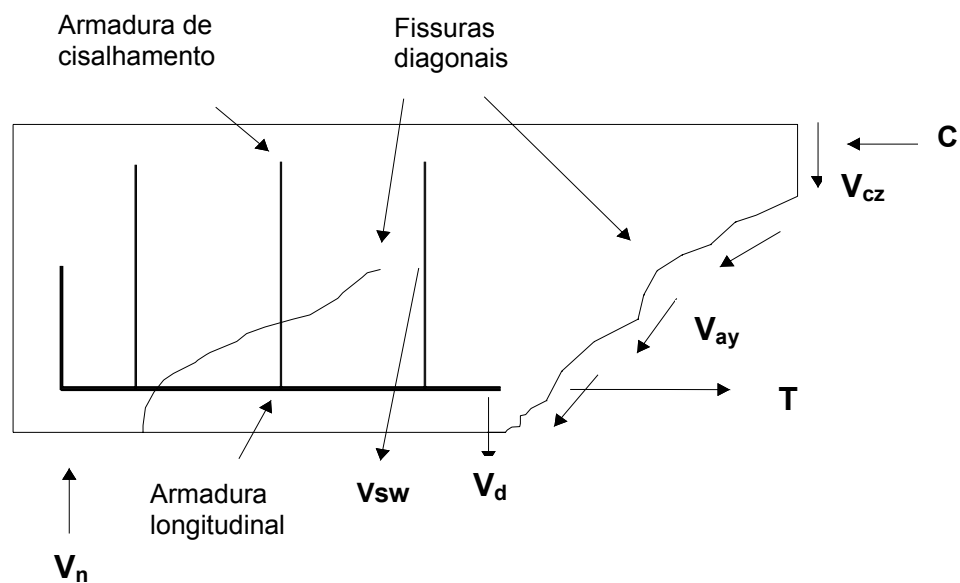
Forças atuantes em uma fissura diagonal numa viga de concreto armado. (BORGES *et al.* 2002)
